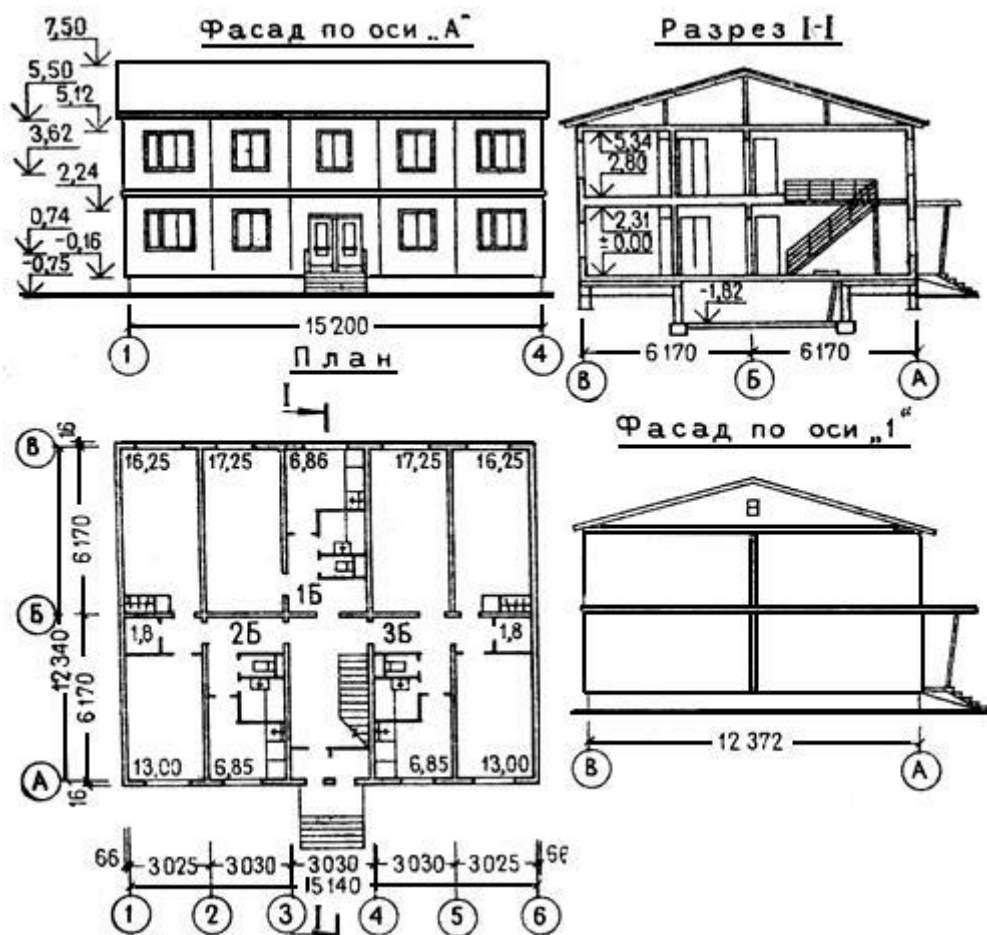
Жилой дом с двумя однокомнатными квартирами, двумя двухкомнатными квартирами и двумя трехкомнатными квартирами, жилая площадь 93 м², общая площадь 141,7 м². Типовой проект СКД-2-6 (к цене N 8)
